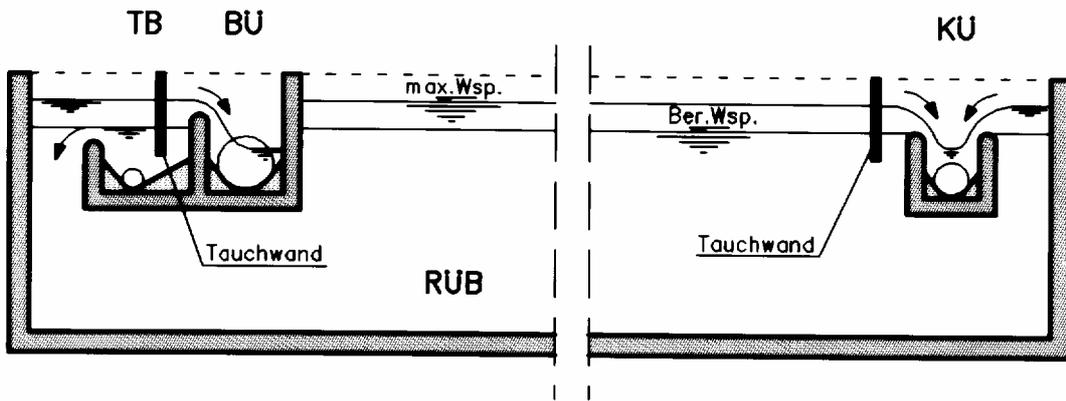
Einlaufgestaltung eines Durchlaufbeckens mit Beschickung des Beckens entgegen der Durchströmungsrichtung, in Kombination mit dem Beckenüberlauf
